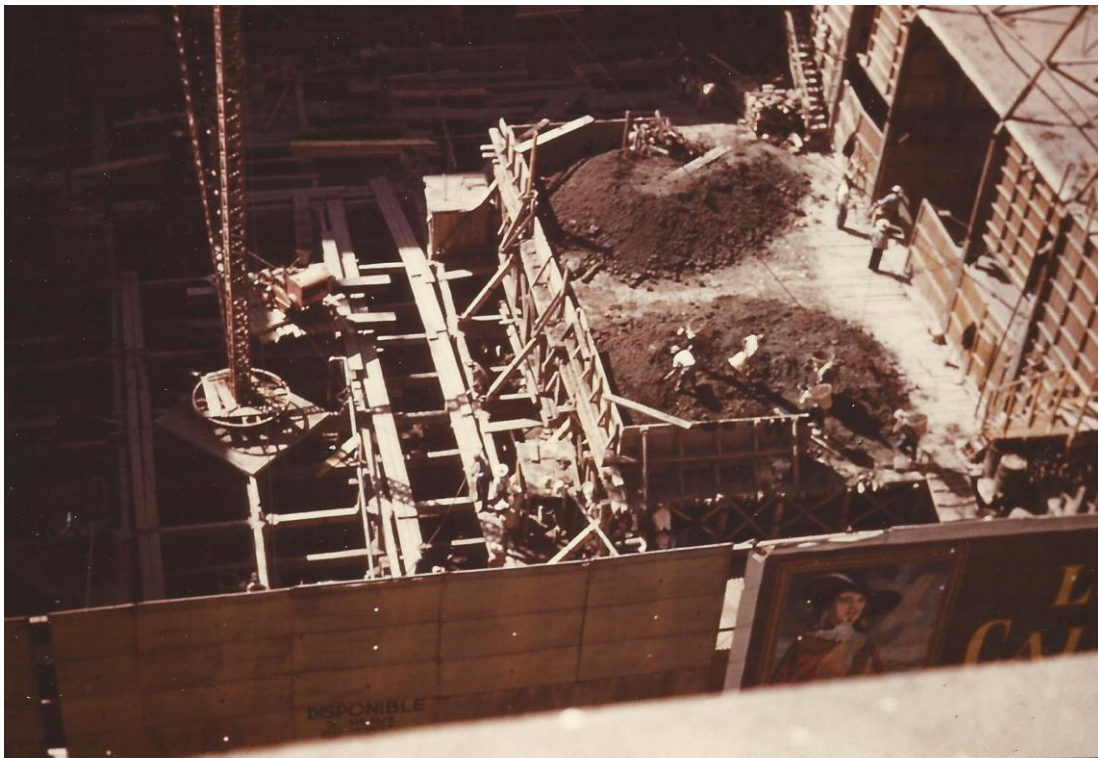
PLATAFORMA DE TRABAJO AL NIVEL DE BANQUETA.
